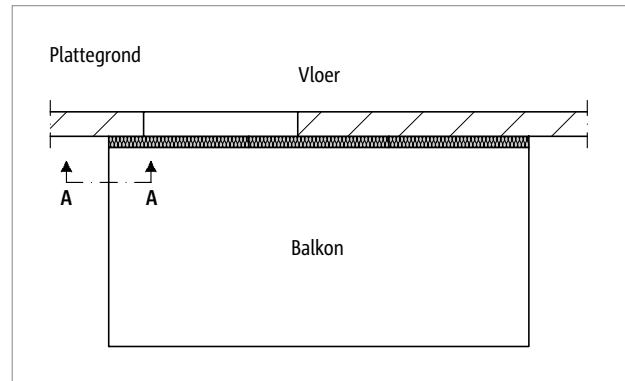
Schöck Isokorb® RT type K: bijlegwapening bij indirecte ondersteuning
